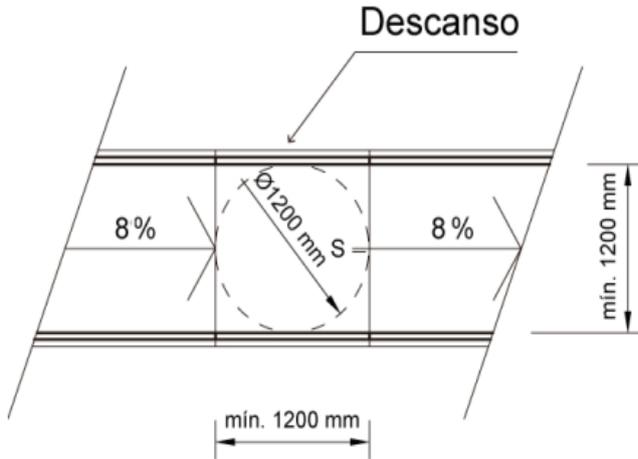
Pendiente Transversal y ancho mínimo
